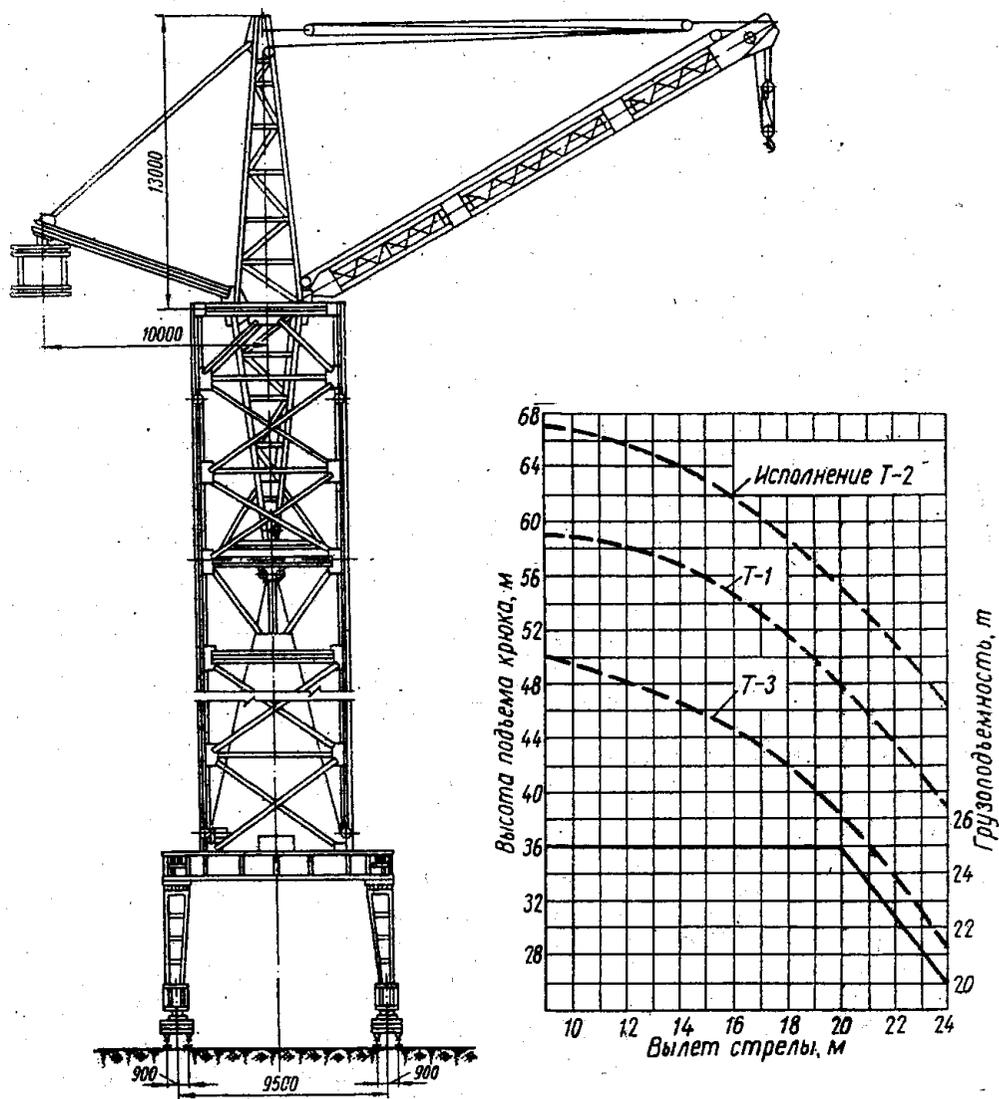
Башенный кран БК-25-48 (Т-1, Т-2, Т-3)
